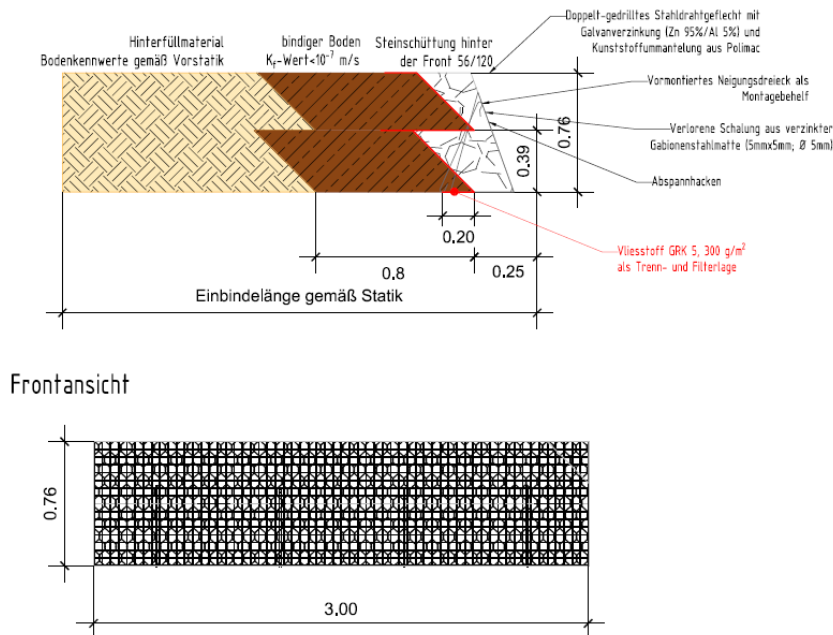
Systemschnitt (Detail) der geplanten Stützkonstruktion (Auszug aus Plan Systemschnitte der Stützkonstruktion von PESCHLA + ROCHMES 2021)
